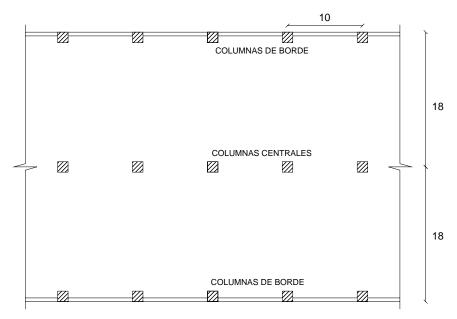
Distribución en Planta de las Columnas Estructurales
